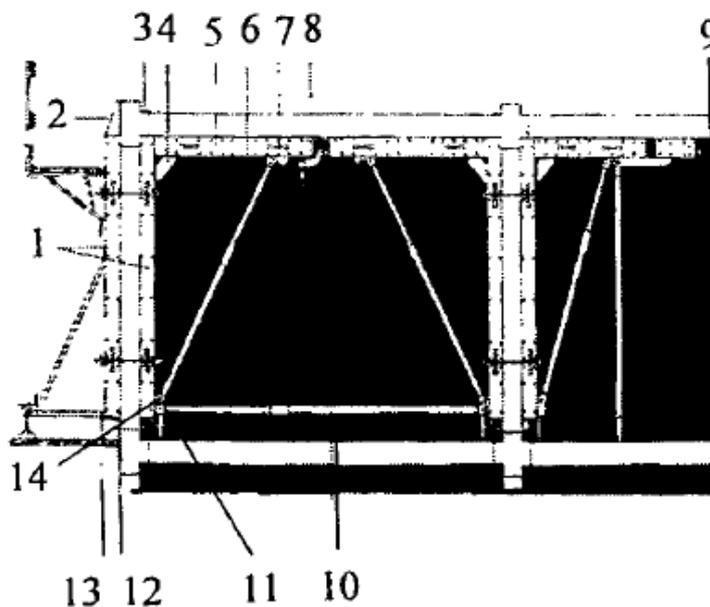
Туннельная опалубка фирмы «НОЕ»:
